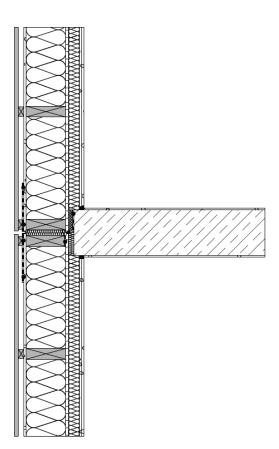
Prinzipskizze: Anschlussdetail einer Stahlbetonwand an eine Außenwand in Holzbauweise [23]
